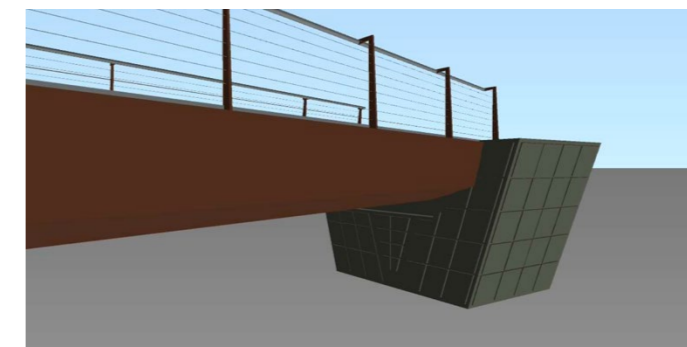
Vista del estribo. Fuente: Elaboración propia.
